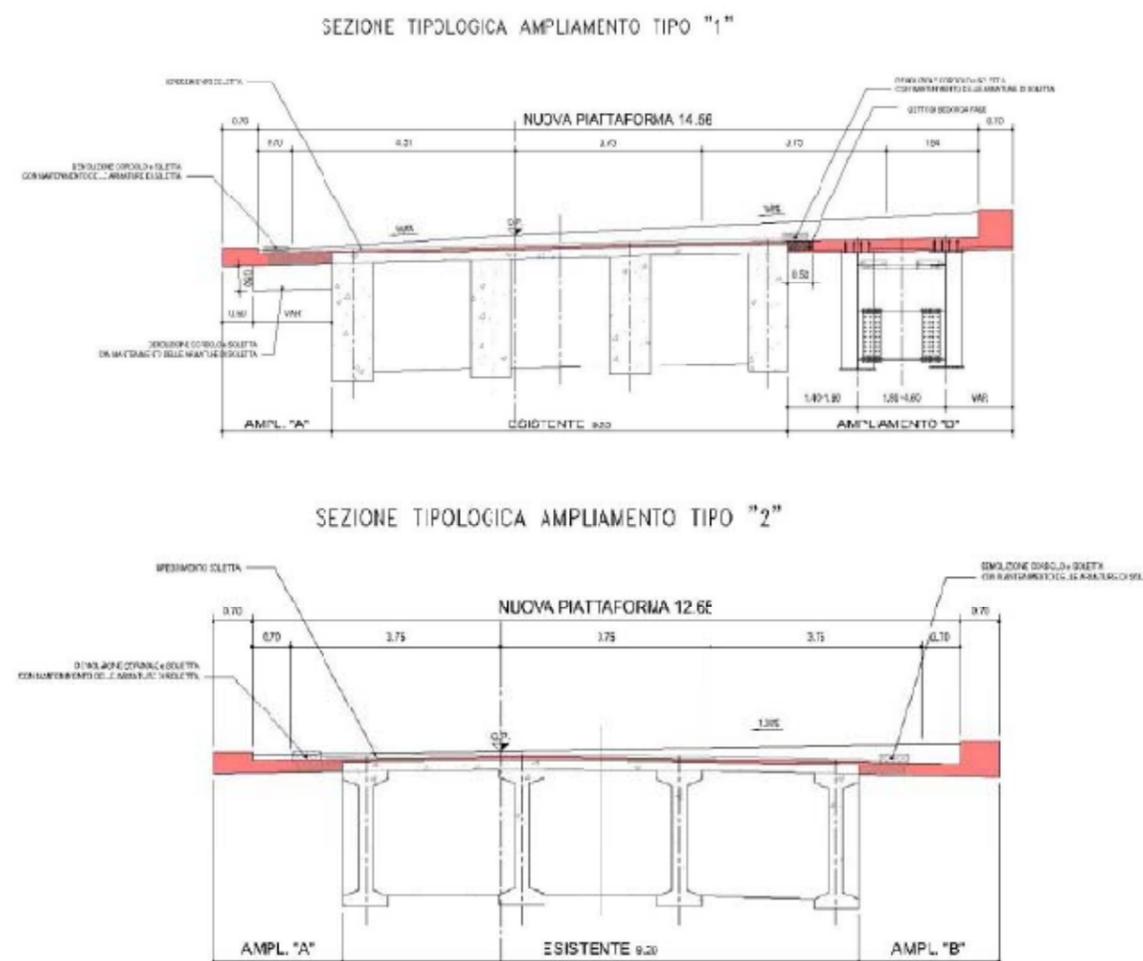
Sezioni trasversali viadotto Secca Nord
